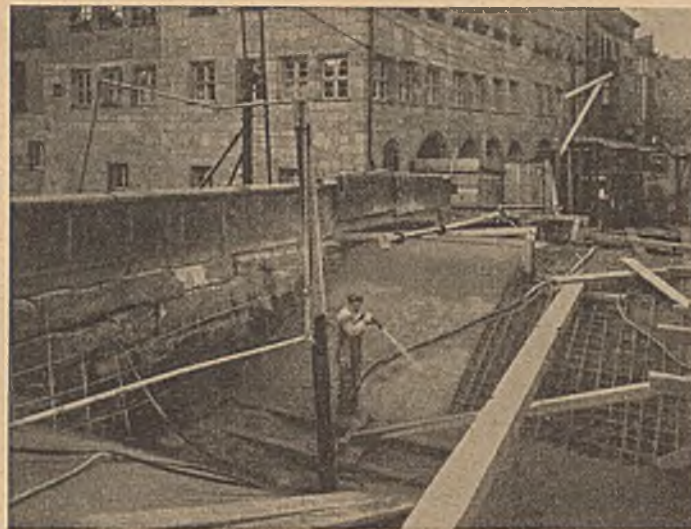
Herstellen der Torkretschale auf dem Gewölberücken.
